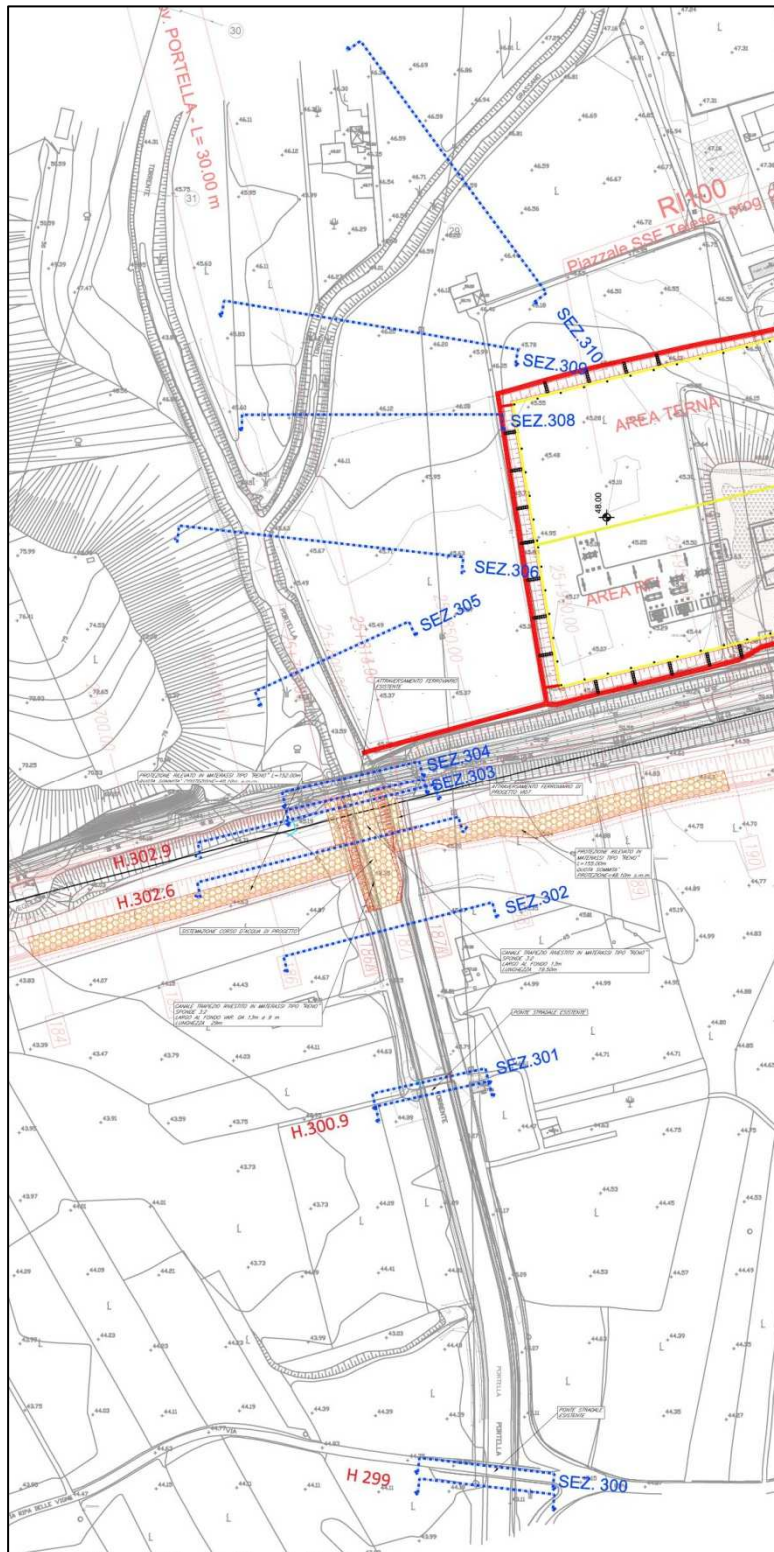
Torrente Portella – Scenario Progetto – RAS - Ubicazione sezioni
